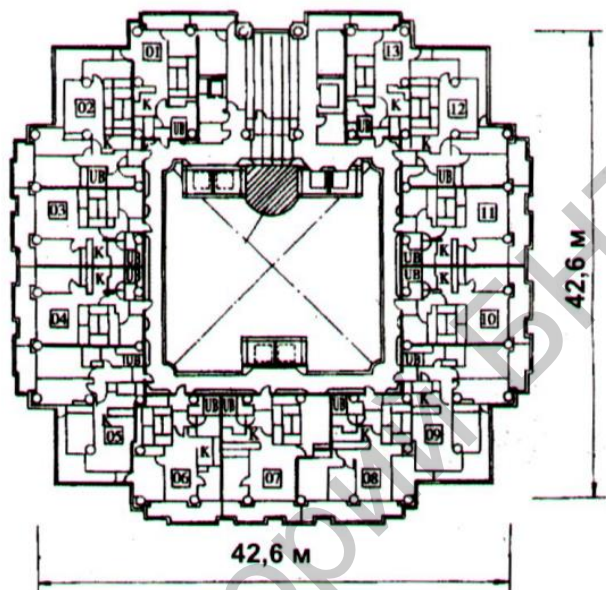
План высотного жилого высотного здания с трубобетонными колоннами в г. Кавачуги, Япония
